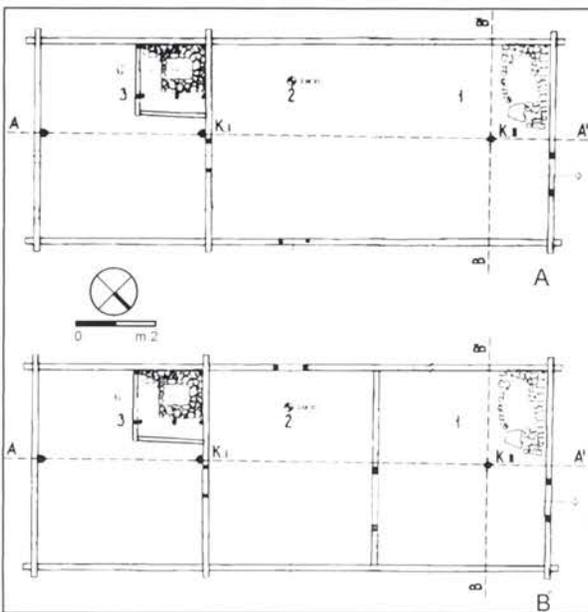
Ducové. Bau 1. Grundlegender Grundriss (A) und nachfolgende Gestaltung (B). Rekonstruktionsversuch (H. Albrecht – A. Ruttkay).
